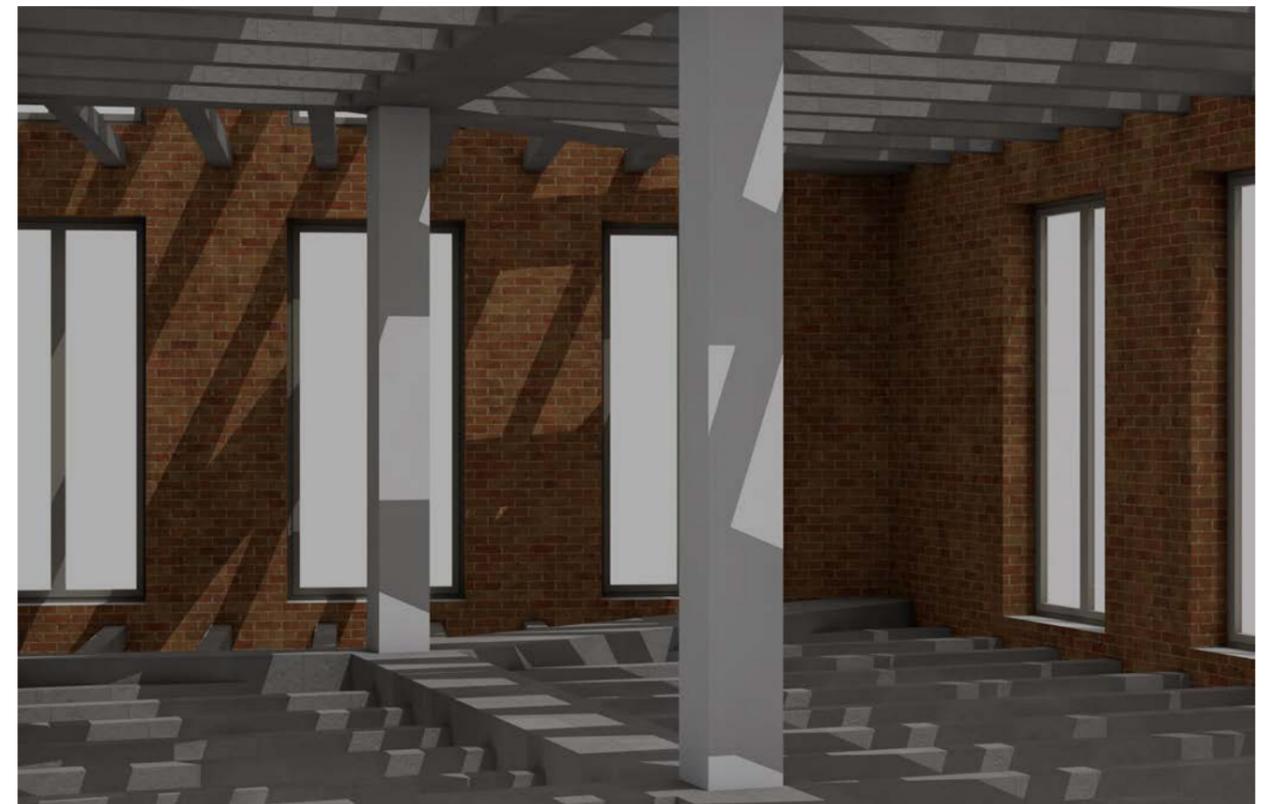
Modelo BIM Archicad. Encuentro estructura con muro estructural de fachada.
